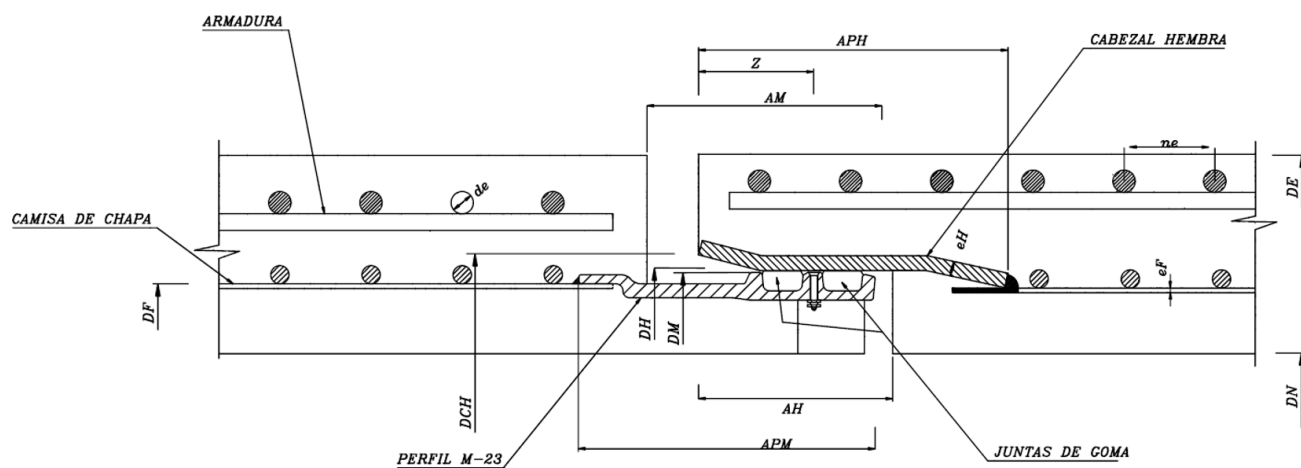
Junta elástica doble en tubería de hormigón armado con camisa de chapa.
